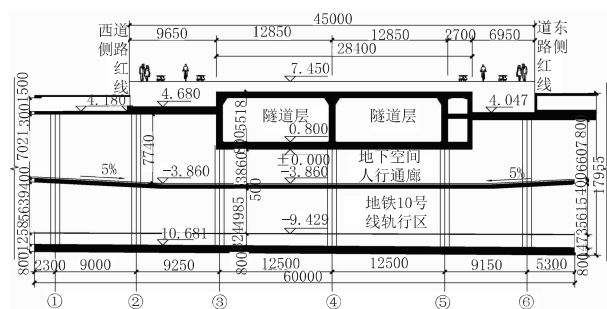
下穿式隧道与地下空间共构断面图(单位:mm)
